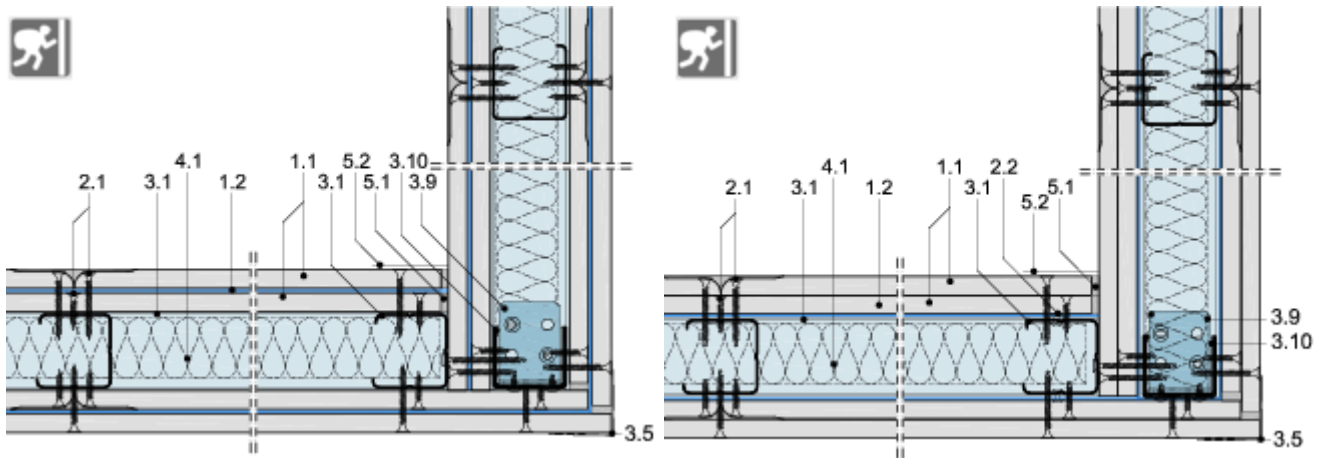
Wandanschluss Doppelständerwand RC 2 mit erhöhtem Schallschutz
